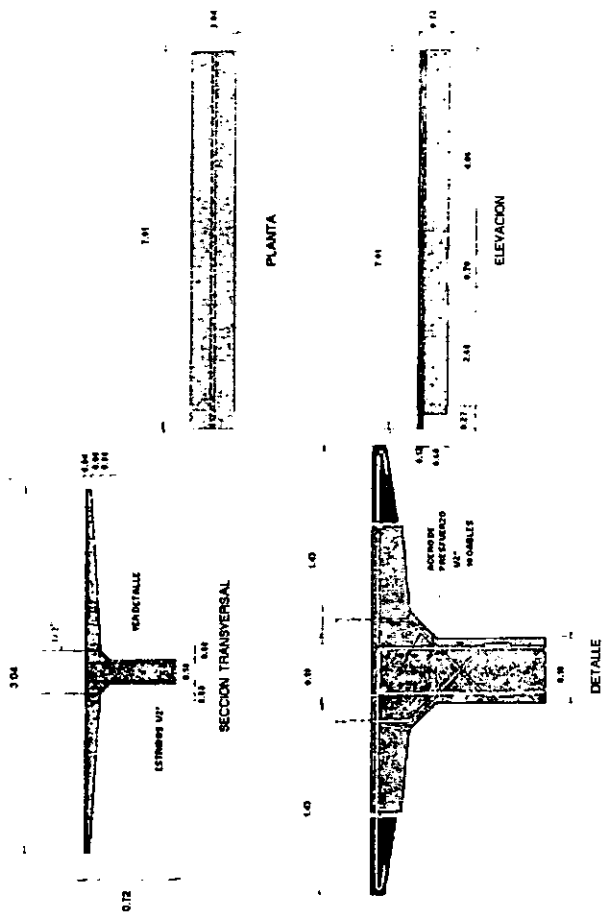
PLANTA, SECCION TRANSVERSAL Y ELEVACION TRABES INTERNA
